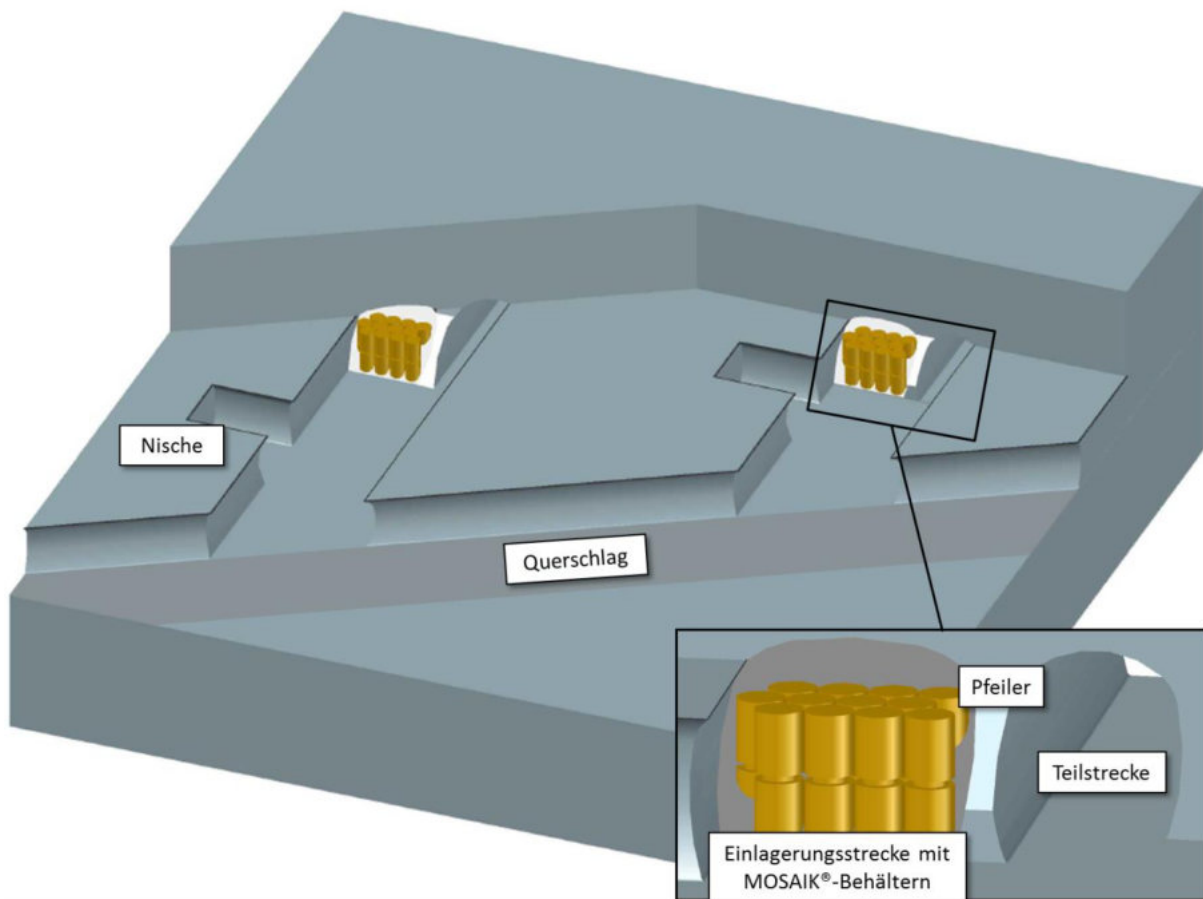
Dreidimensionale Darstellung der neuen, befüllten Einlagerungsstrecke, der Teilstrecke zur Rückholung und des verbleibenden Pfeilers mit Nische und Zugangsstrecke
